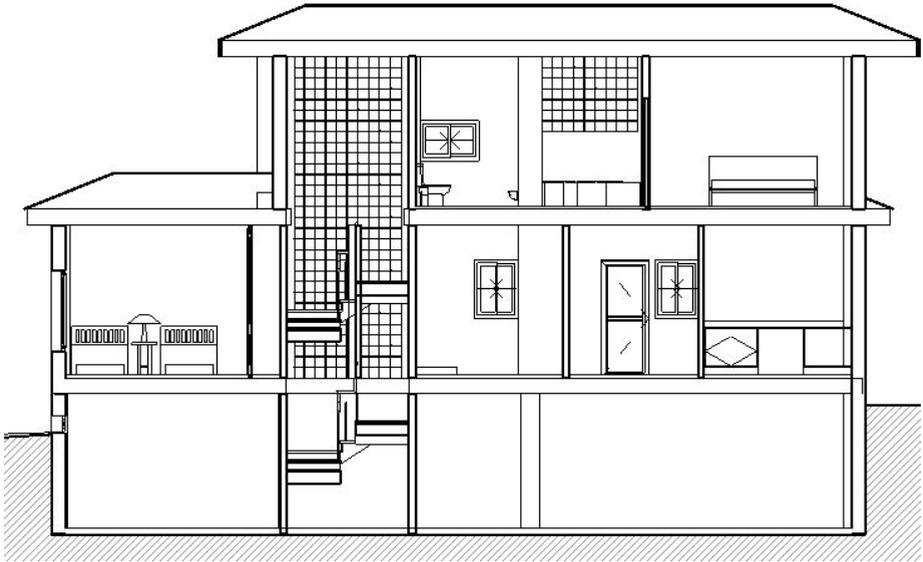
Sección 4 - 4' . Fuente propia Revit
